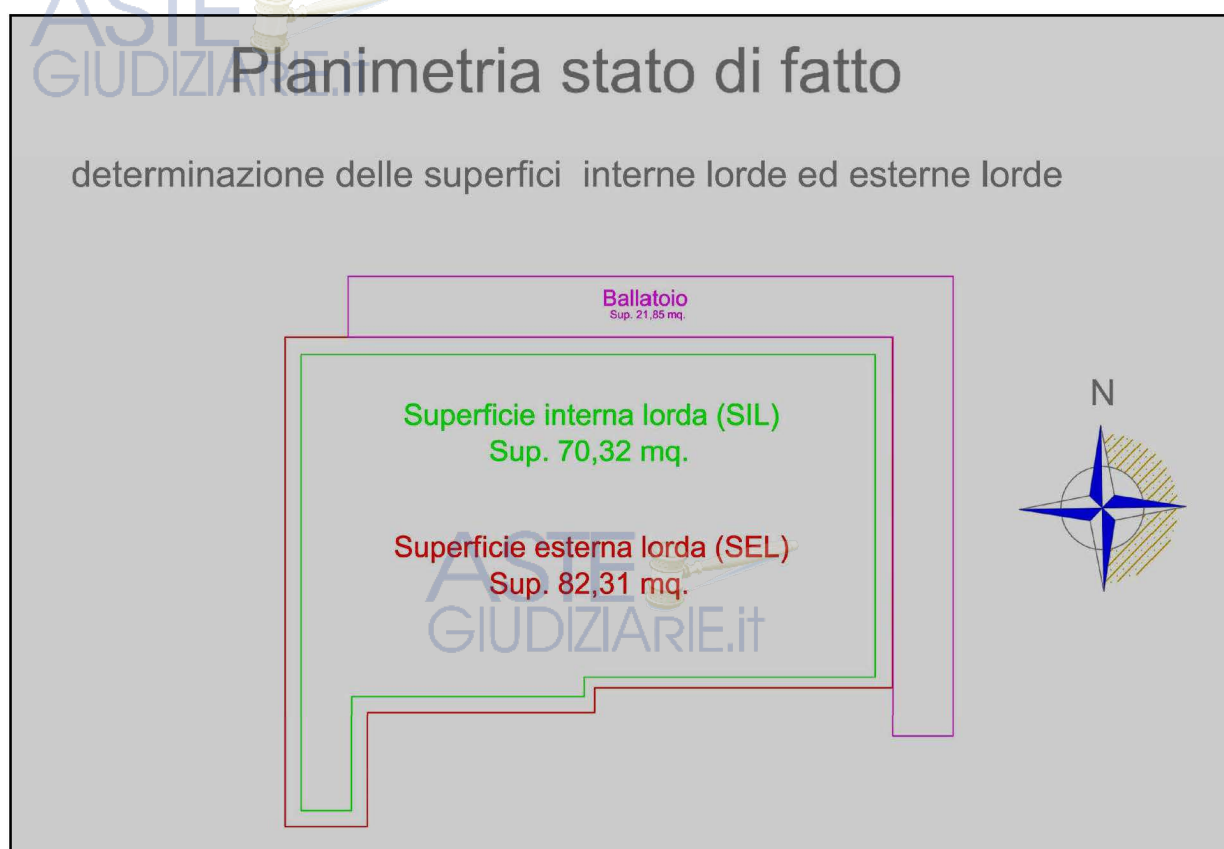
Visualizzazione della planimetria dell'immobile riportante le superfici coperte
